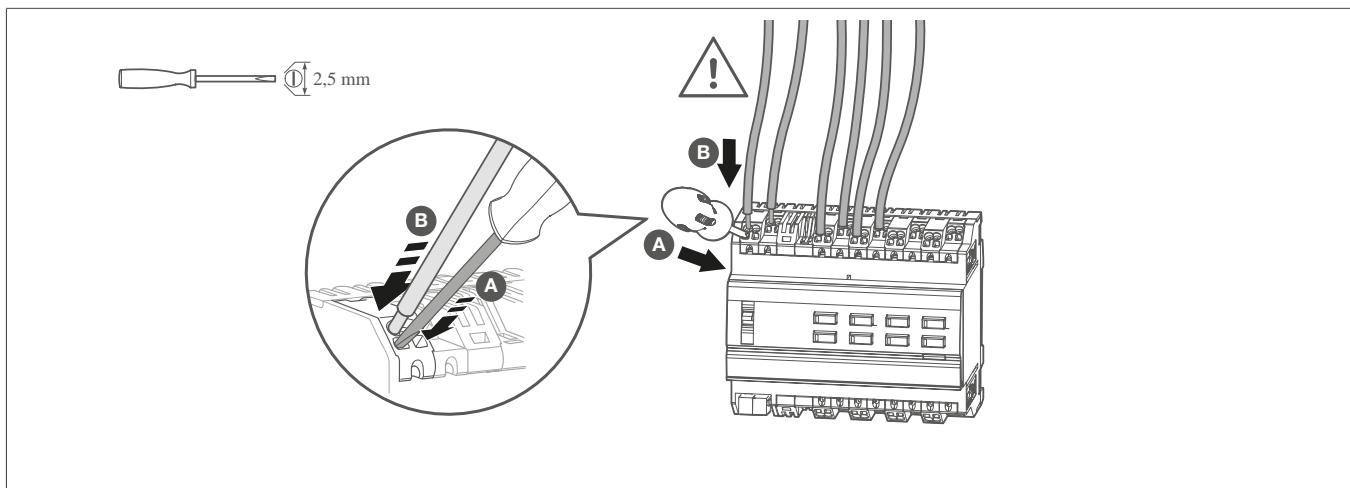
Collegamento dell'apparecchio con il morsetto a innesto
